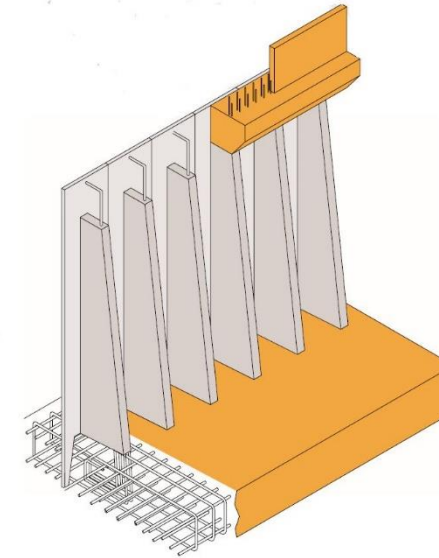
Esquema del estribo. Fuente: Catálogo Nortén.
